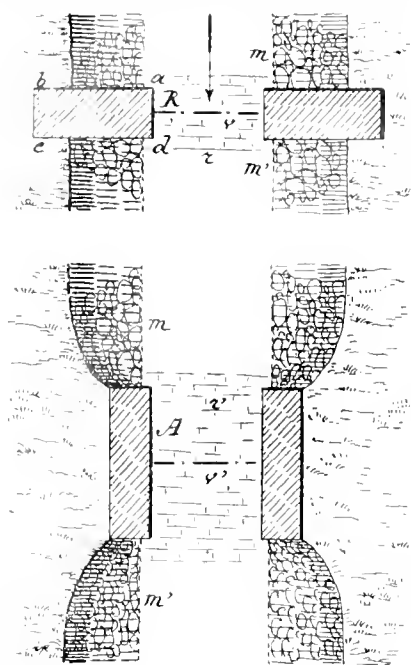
Vue en plan d'un mur en retour et d'un mur en ailes.
